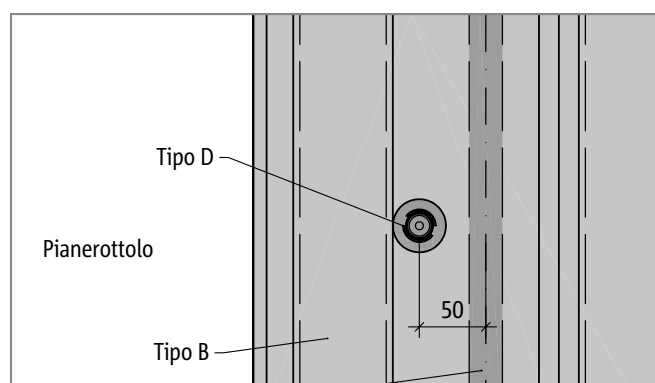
Schöck Tronsole® tipo B + tipo D: Dettaglio A
